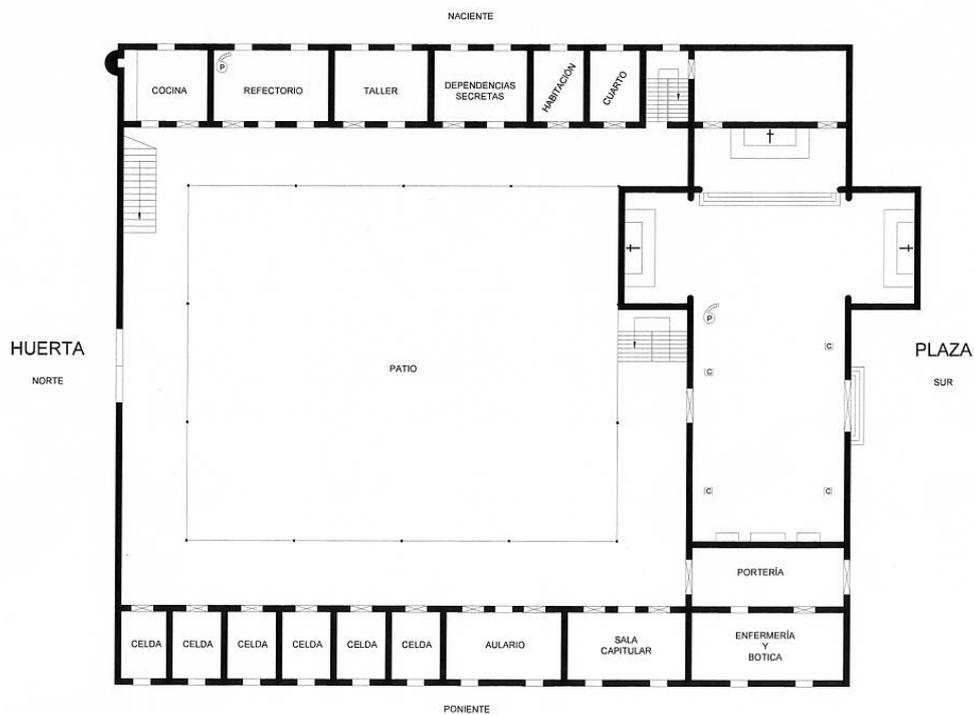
Figura I. Reconstrucción de la iglesia y casa conventual. Planta baja. Elaboración propia.
